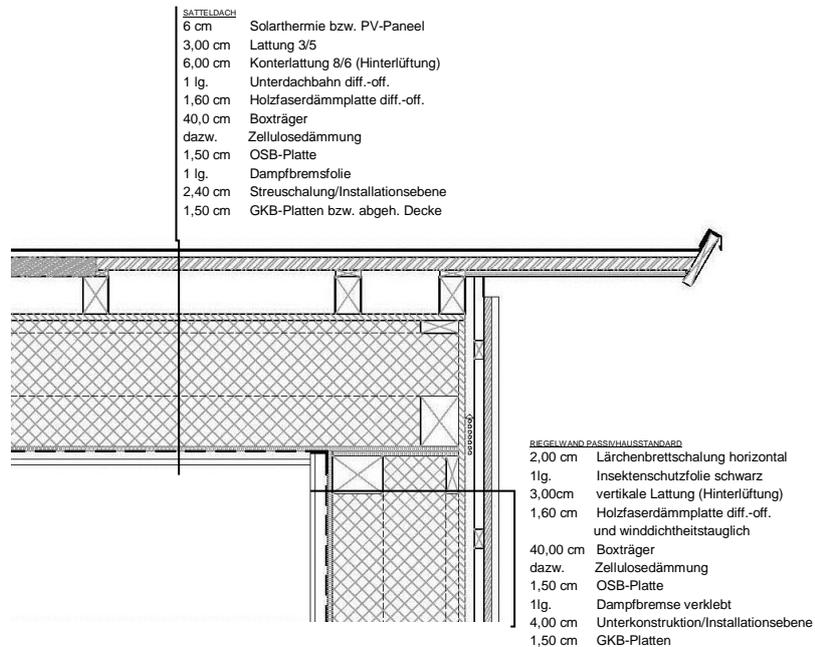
Detailausbildung Ortgang – der Dachvorstand wurde oberhalb der Dämmebene hergestellt.
